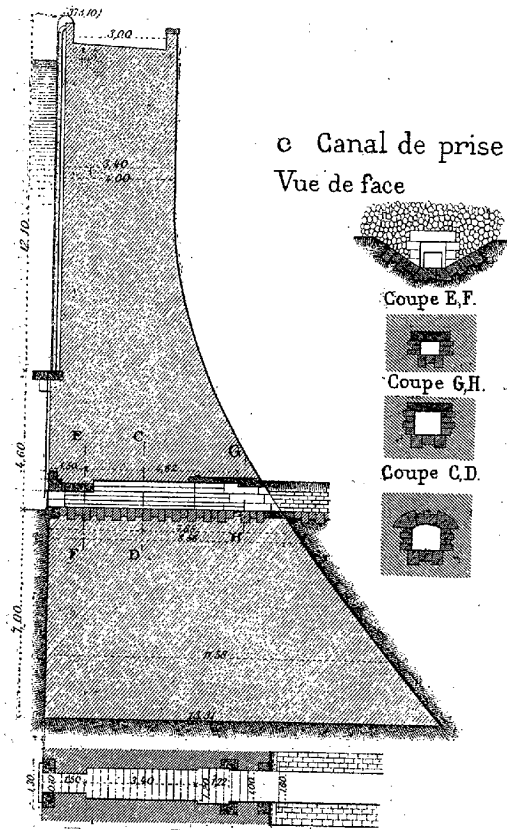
RÉSERVOIR DE BOUZEY; ÉLEVATION D'AMONT ET PLAN DE LA DIGUE EN MAÇONNERIE.
